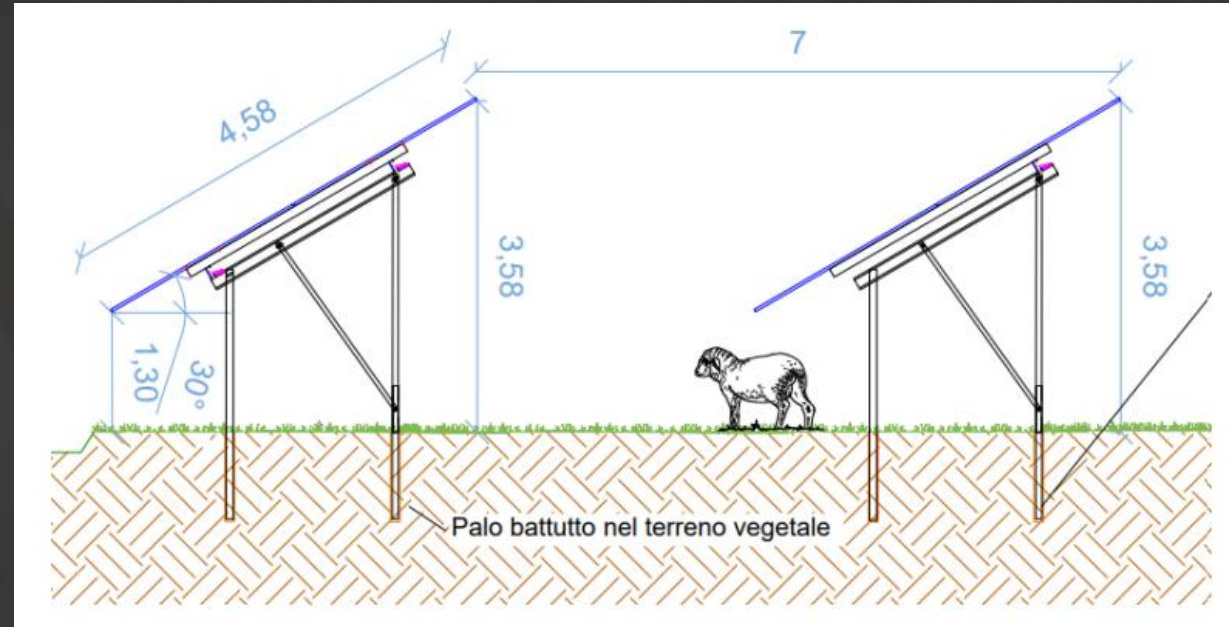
Vista in sezione laterale della struttura tipo, con altezze minime e massime raggiunte dai moduli
